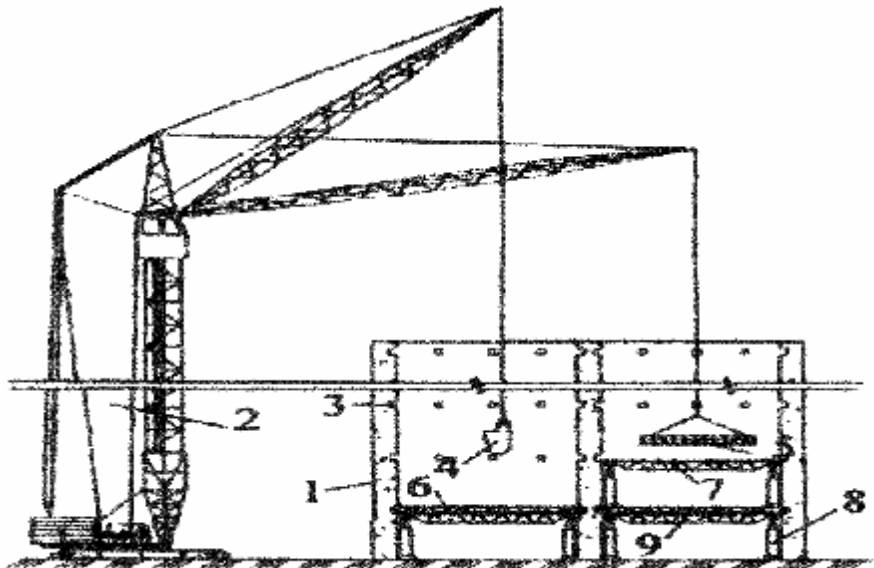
Бетонування міжповерхових перекриттів методом “знизу вверх”: 1 – монтажні стіни; 2 – кран; 3 – штраба; 4 – баддя для подачі бетонної суміші; 5 – армо-каркас; 6 – опалубка перекриття; 7 – прогін у вигляді ферми; 8 – телескопічна стійка; 9 – монолітне перекриття
